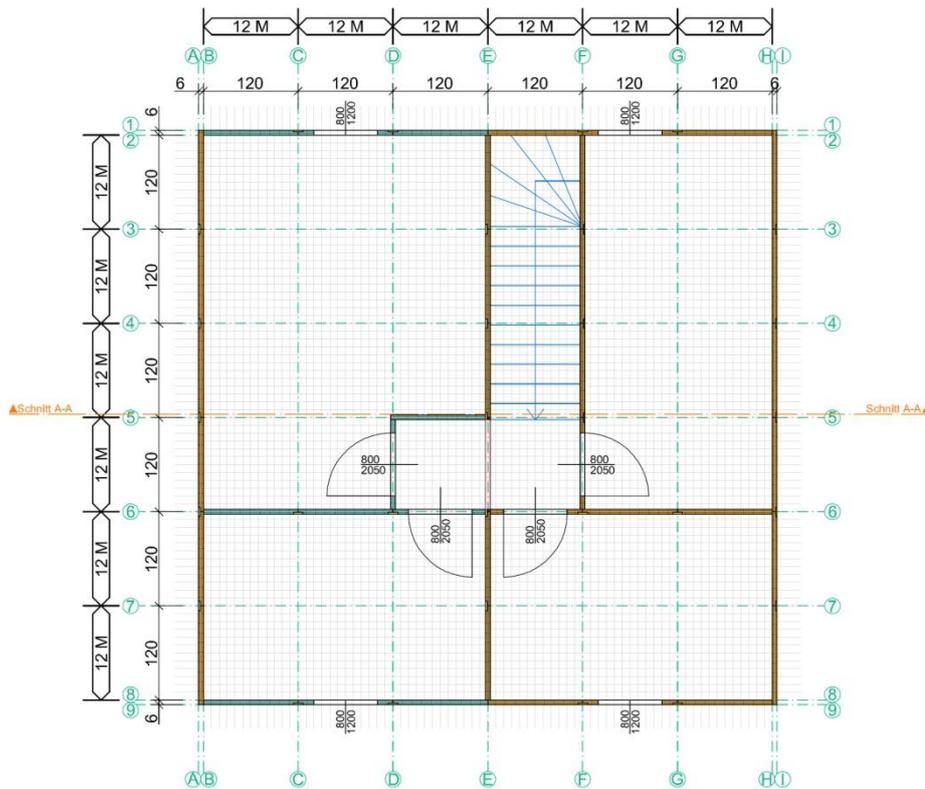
Grundriss des Obergeschosses in der Erweiterungsstufe
